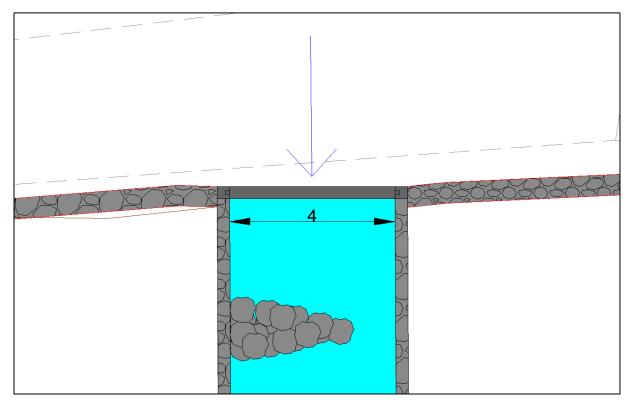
Rivière de contournement – Entrée hydraulique – Vue en plan
